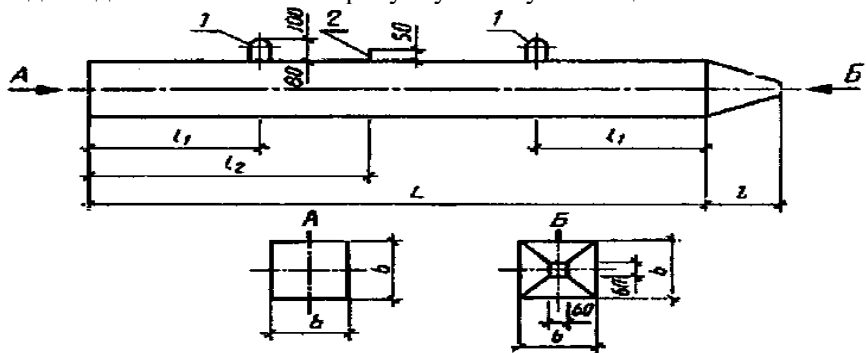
Палі типу ПН із суцільним квадратним перерізом, з поперечним армуванням стовбура з напруженою поздовжньою
